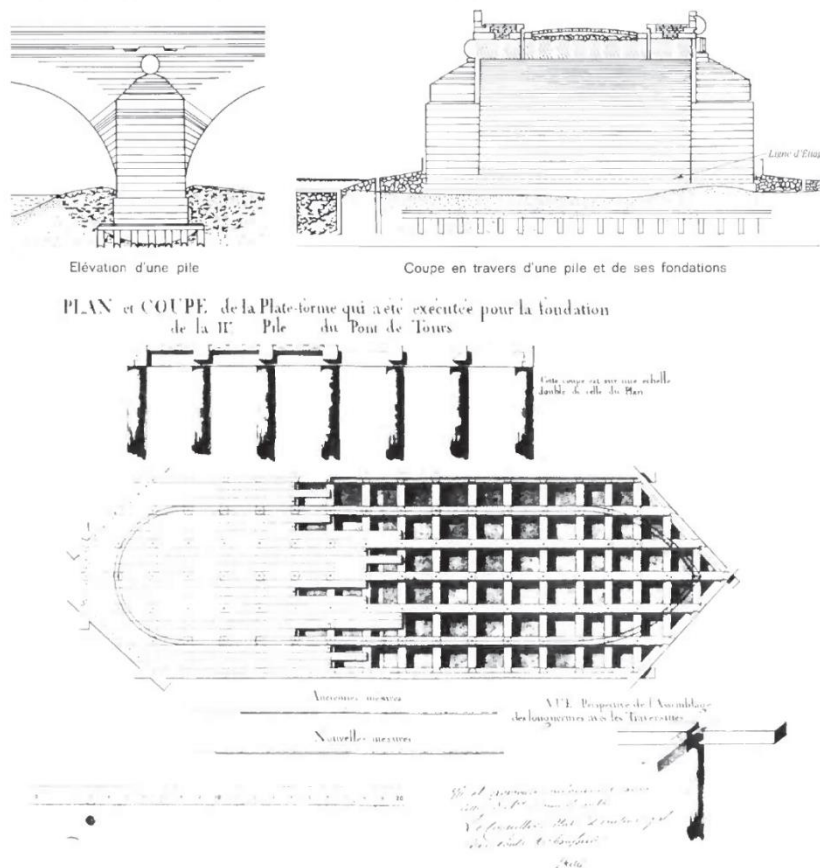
Fondazione su pali con testa bloccata da macerie: elevazione di una pila (in alto a sinistra), sezione trasversale di una pila e delle sue fondazioni (in alto a destra), pianta e sezione della piattaforma eseguita per la realizzazione della seconda pila del Ponte Wilson a Tours (in basso). [18]
